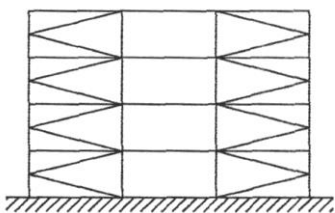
Рама з К-подібними в'язями (не допускається до застосування)
